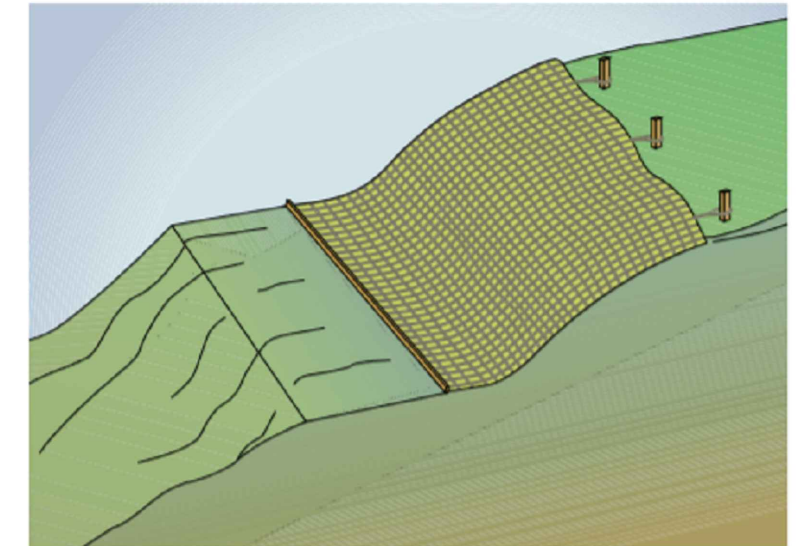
Escavação protegida – com estruturas denominadas "cortinas"
